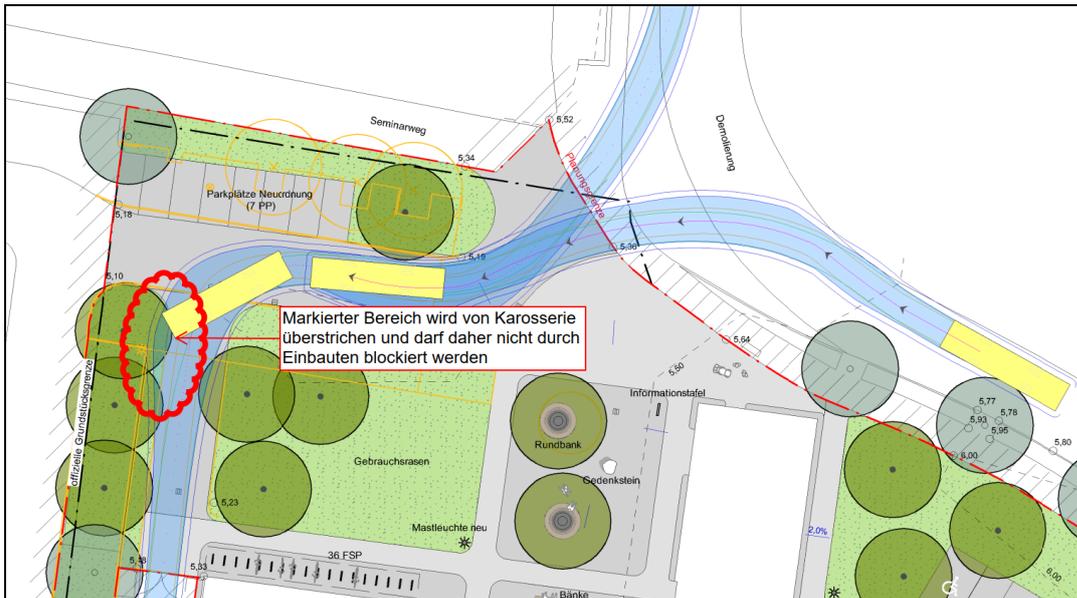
Einfahrt Feuerwehr – Parkierungsanlage West
